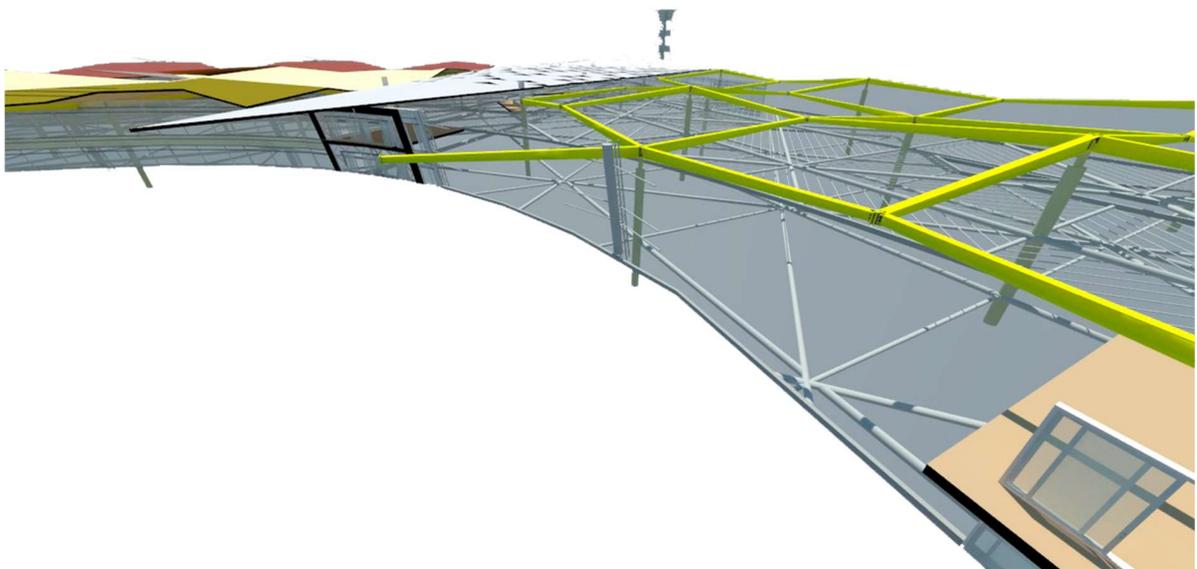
Estructura Aeropuerto. Fuente: Autores
